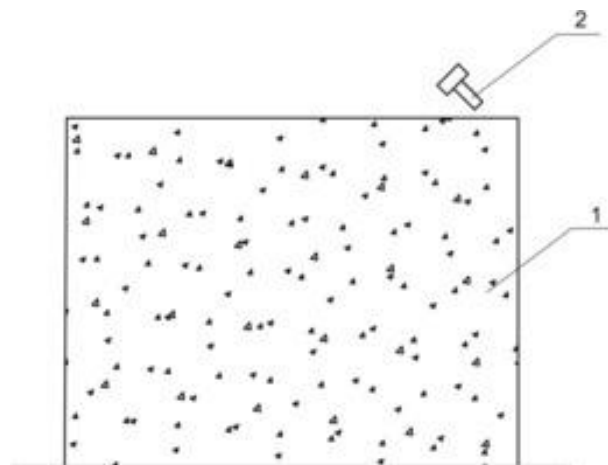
混凝土构件裂缝敲击巡检示意图
